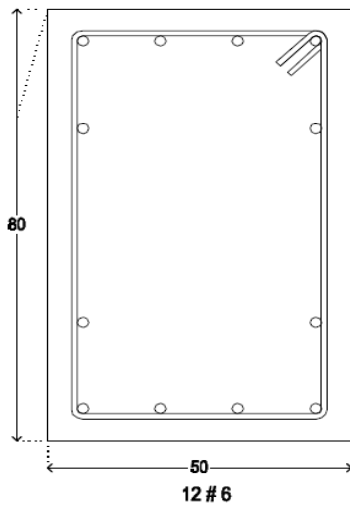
Arreglo de zapata corrida ZC-1 para edificio eléctrico
